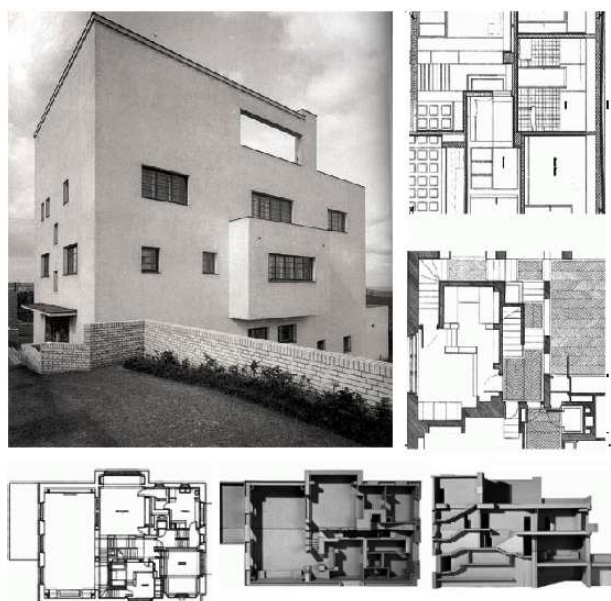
Plans, coupe et volumétrie de la Villa Müller d'Adolf Loos
